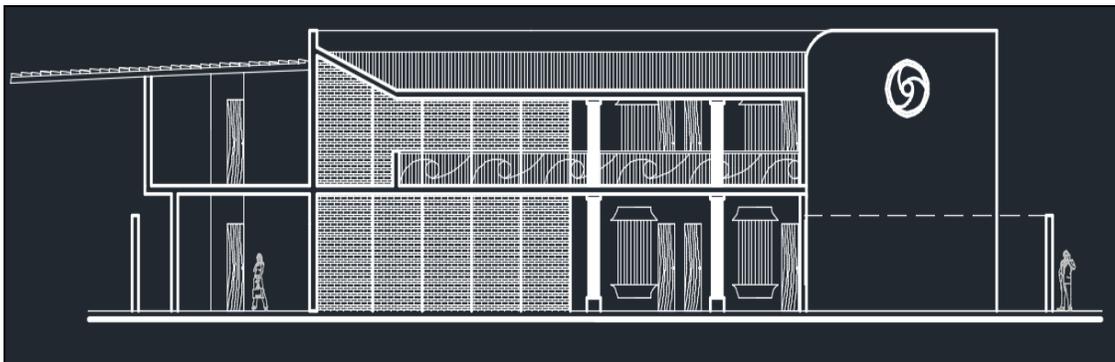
Fachada de vivienda. (Rosa A, 2023).
